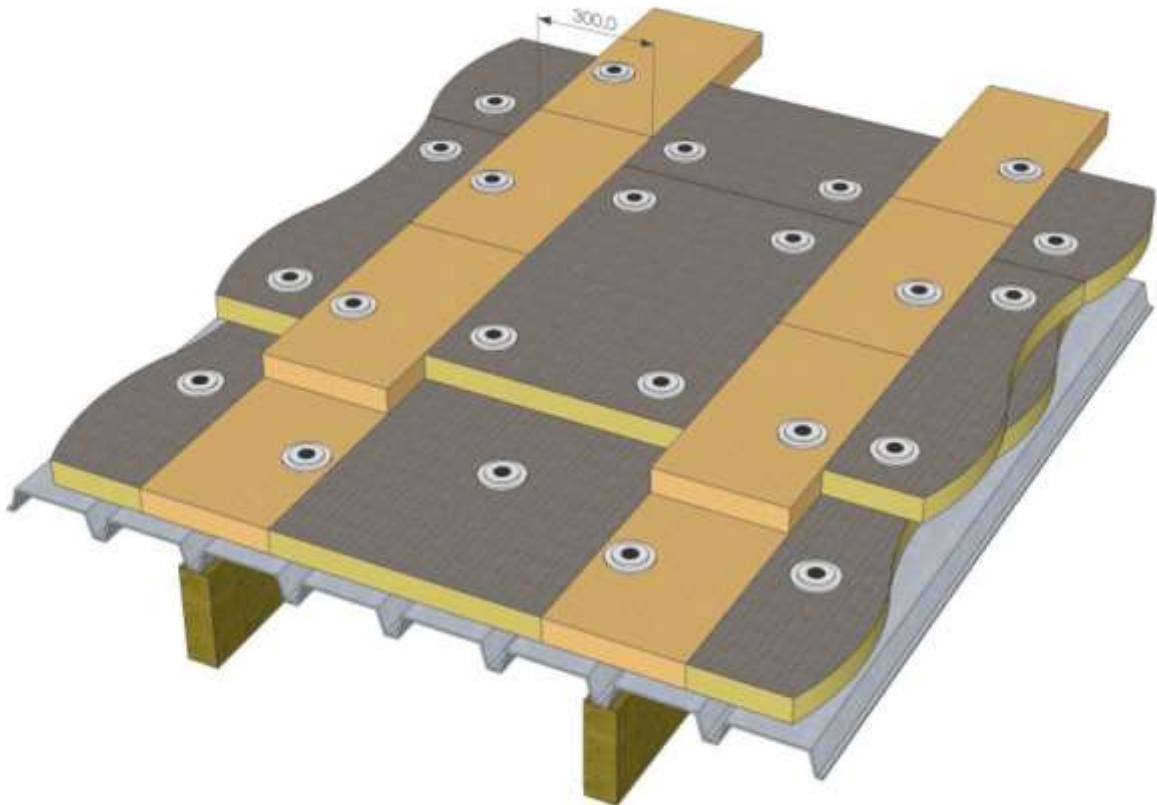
POWERDECK+ en ERP sans écran thermique (pose en 2 lits) : Exemple de recouvrement au droit d'un mur ou d'un écran de cantonnement parallèle aux ondes (la charpente n'est pas représentée)
